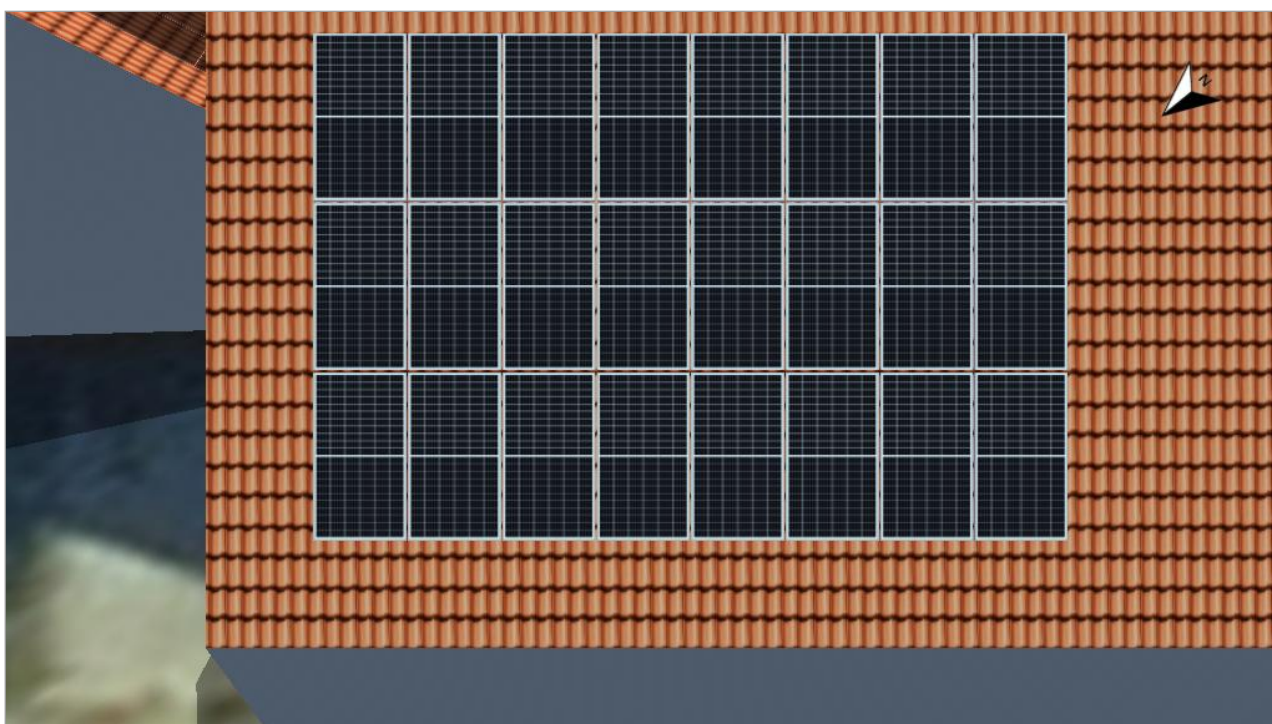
Plocha modulu - Building 05-Roof Area Southwest
